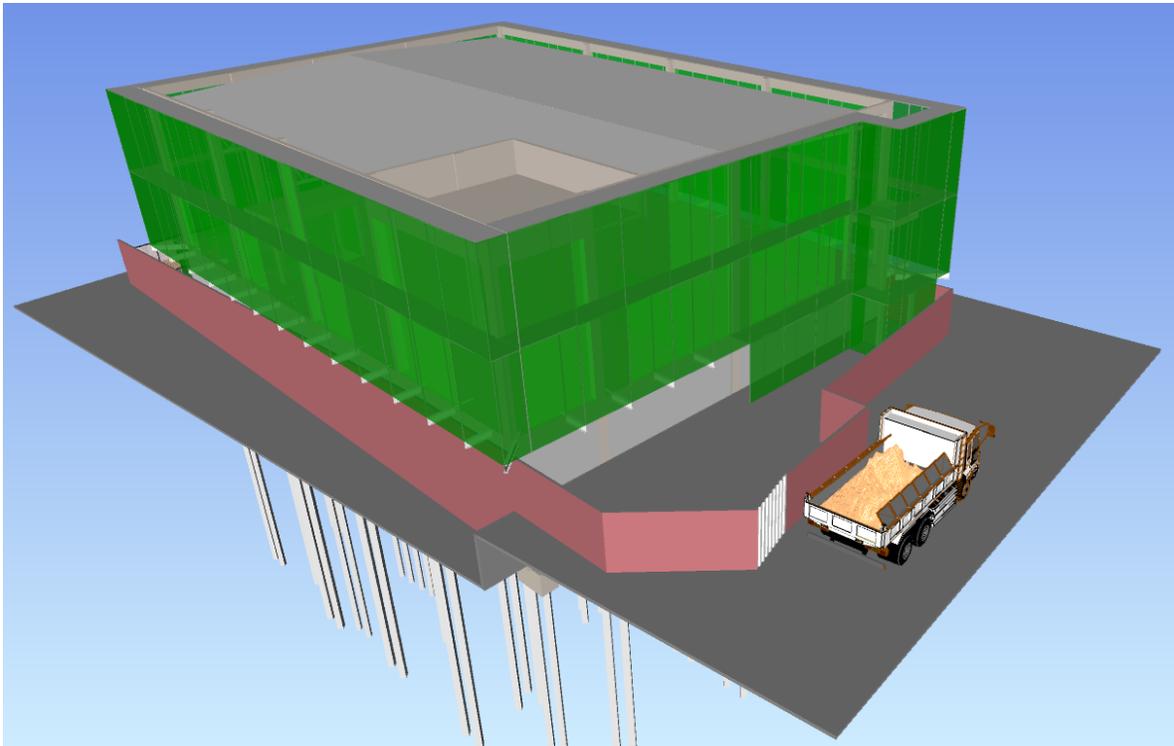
Simulação Navisworks: execução de andaimes fachadeiros 2º pavimento, estrutura e telhamento cobertura
